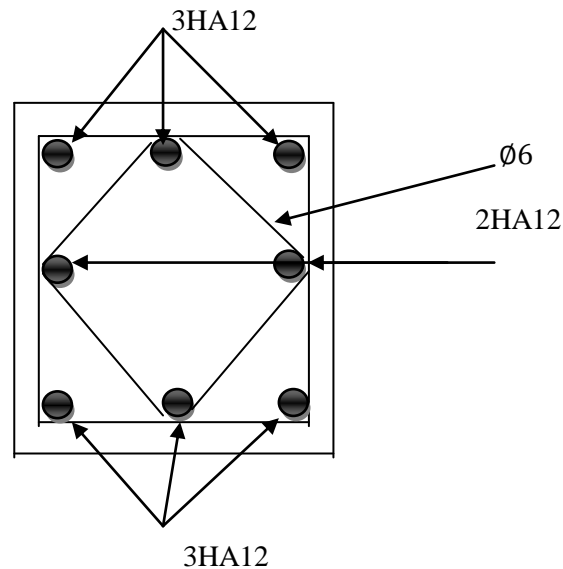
schéma de ferrailage des poteaux (RDC et 1^{er} et 2^{ème} et 3^{ème} étage)
